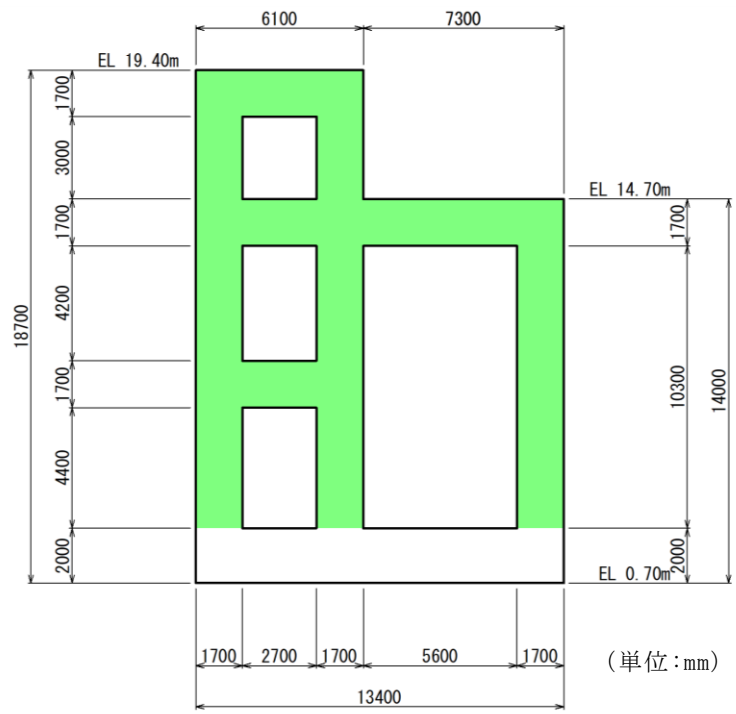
第 1 ベントフィルタ格納槽断面図 (A-A 断面位置)
